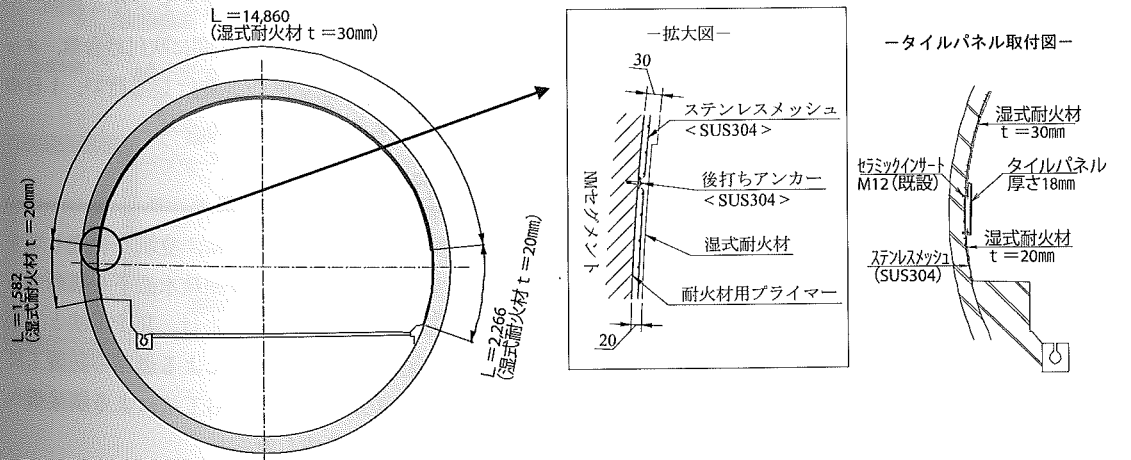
湿式耐火吹付け工施工断面およびタイルパネル取付図
